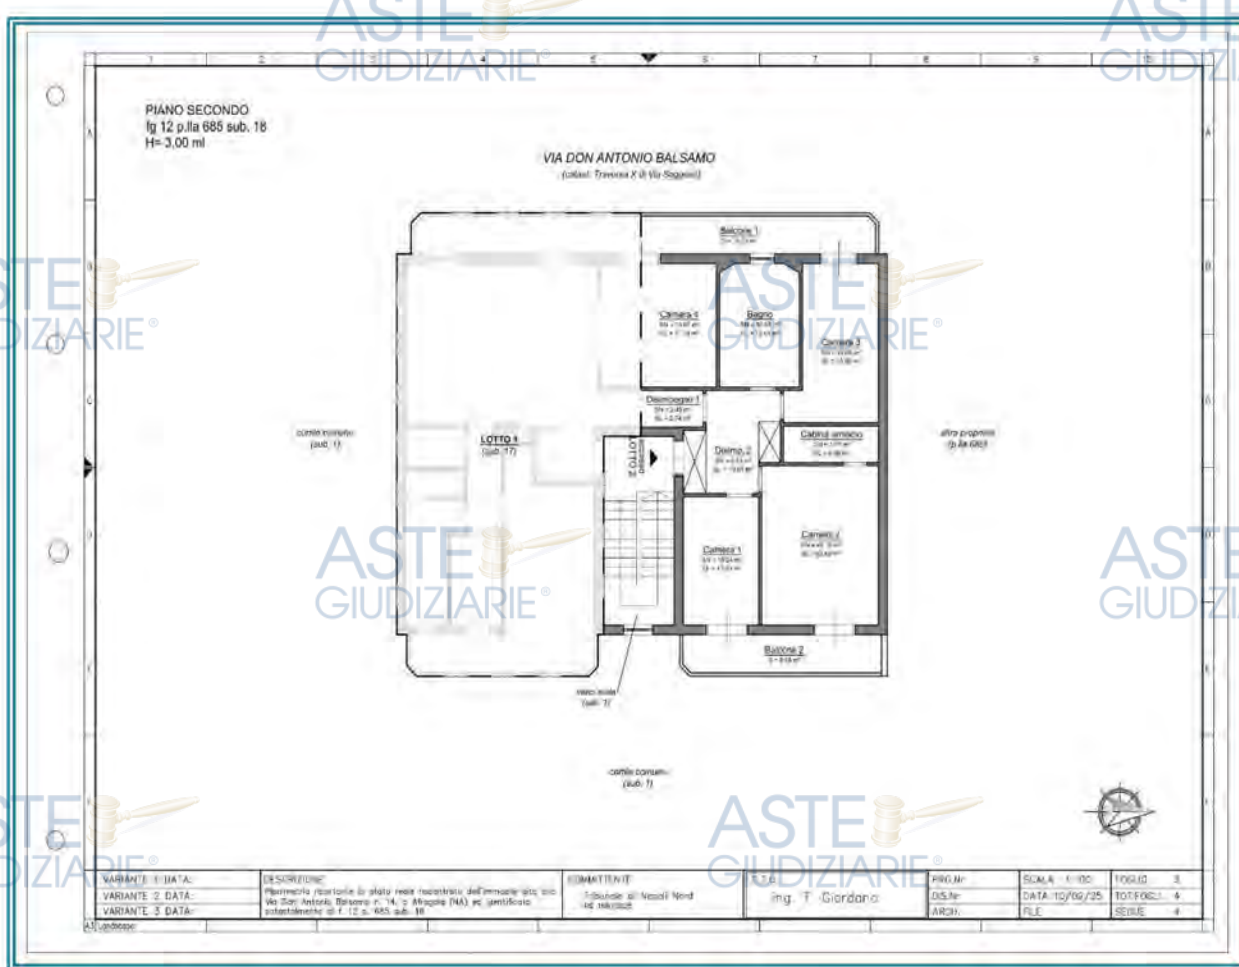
Stato attuale - Piano Secondo (LOTTO 2)
